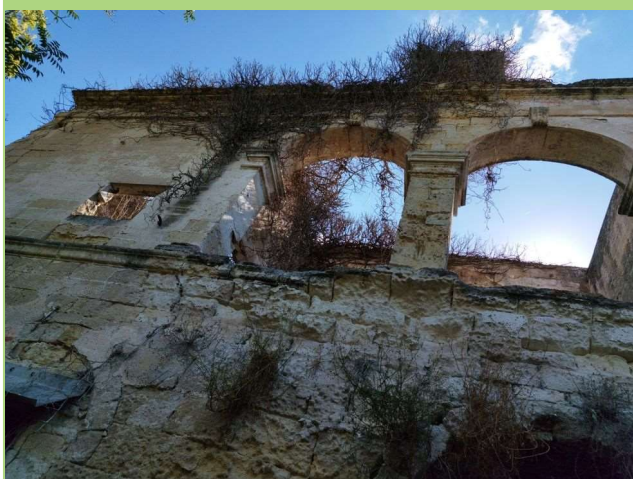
Particolare del fronte di Masseria Buffoluto (B.4.a.a), invasa dall'ailanto.
